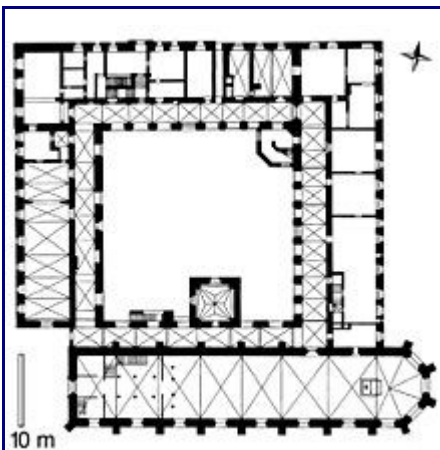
Grundriss von Kirche und Konvent
